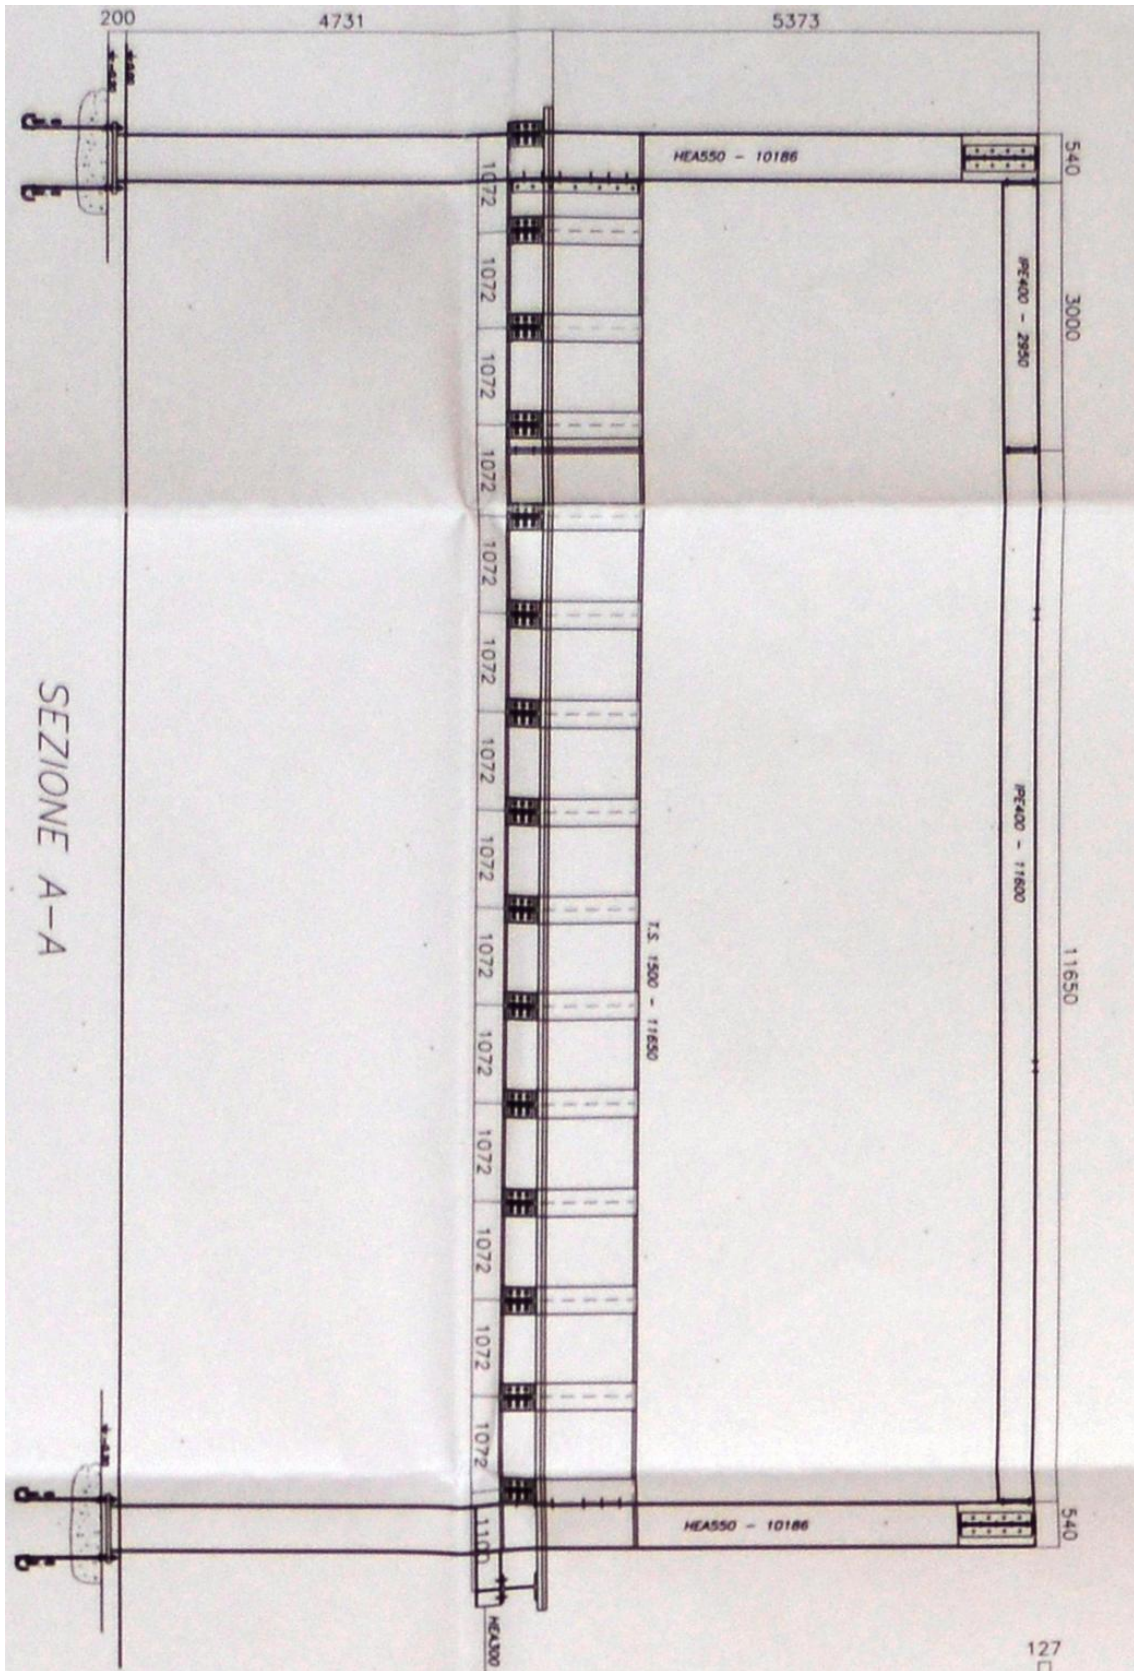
Particolare di A.2003.a.us.b.T05 - Sezioni - Sezione A-A
